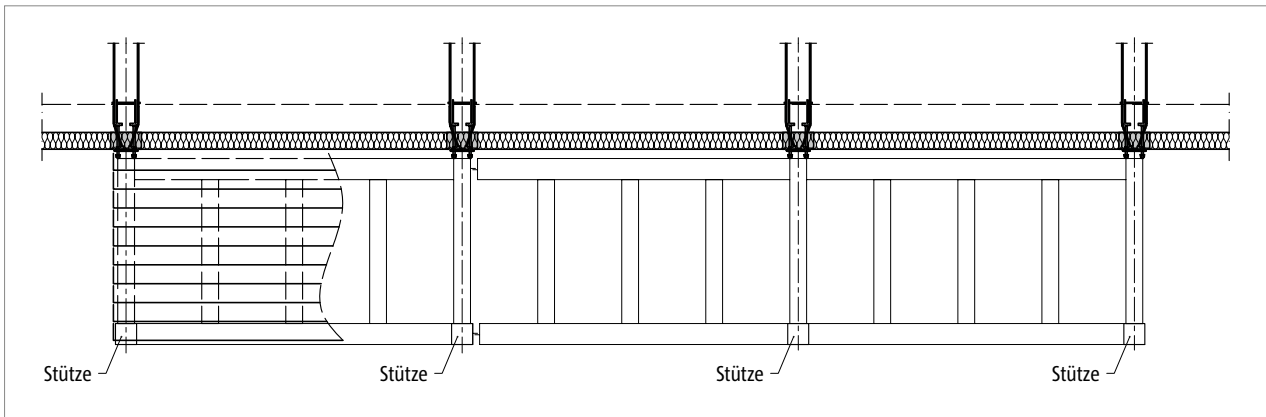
Schöck Isokorb® XT Typ SQP: Balkon mit Stützenlagerung
